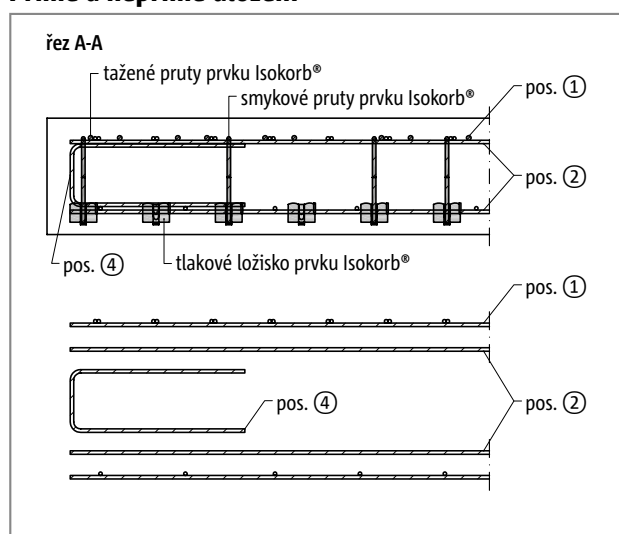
Schöck Isokorb® typ KXT: Napojovací stavební výztuž u přímého uložení
